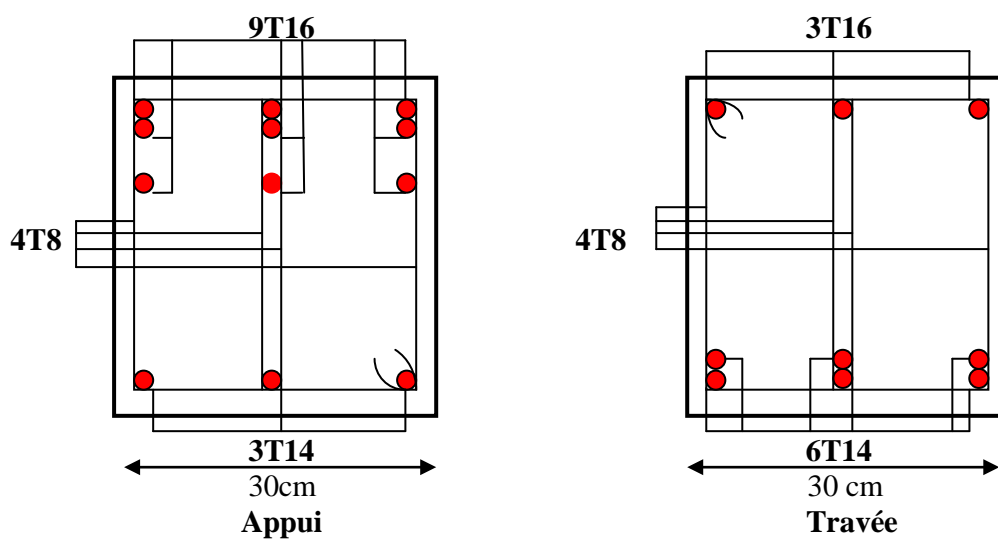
Schéma de ferrailage de poutre principale étage 1
